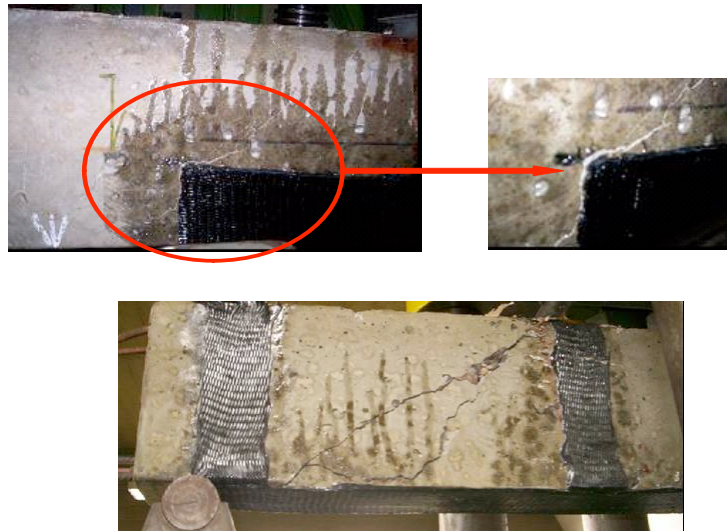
Tipo de falla de vigas dañadas y reparadas con PRFC
